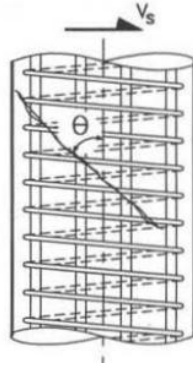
Angulo de la fisura de corte utilizado en el cálculo de la resistencia que provee el acero al corte (Priestley, Seible y Calvi 1996)
